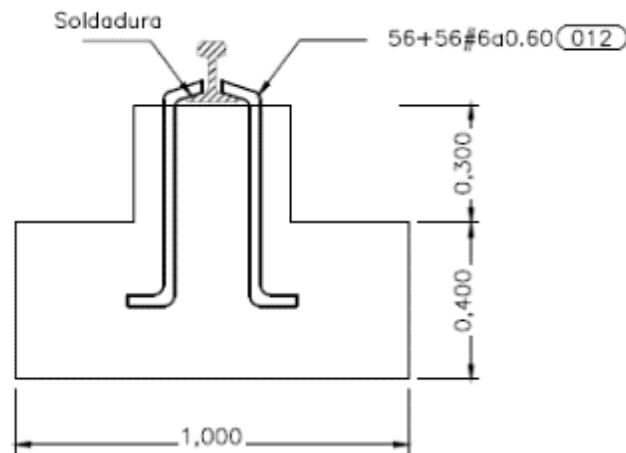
Vista en alzado de la estructura de cimentación de una grúa pórtico de 80 t (unidad: m)
